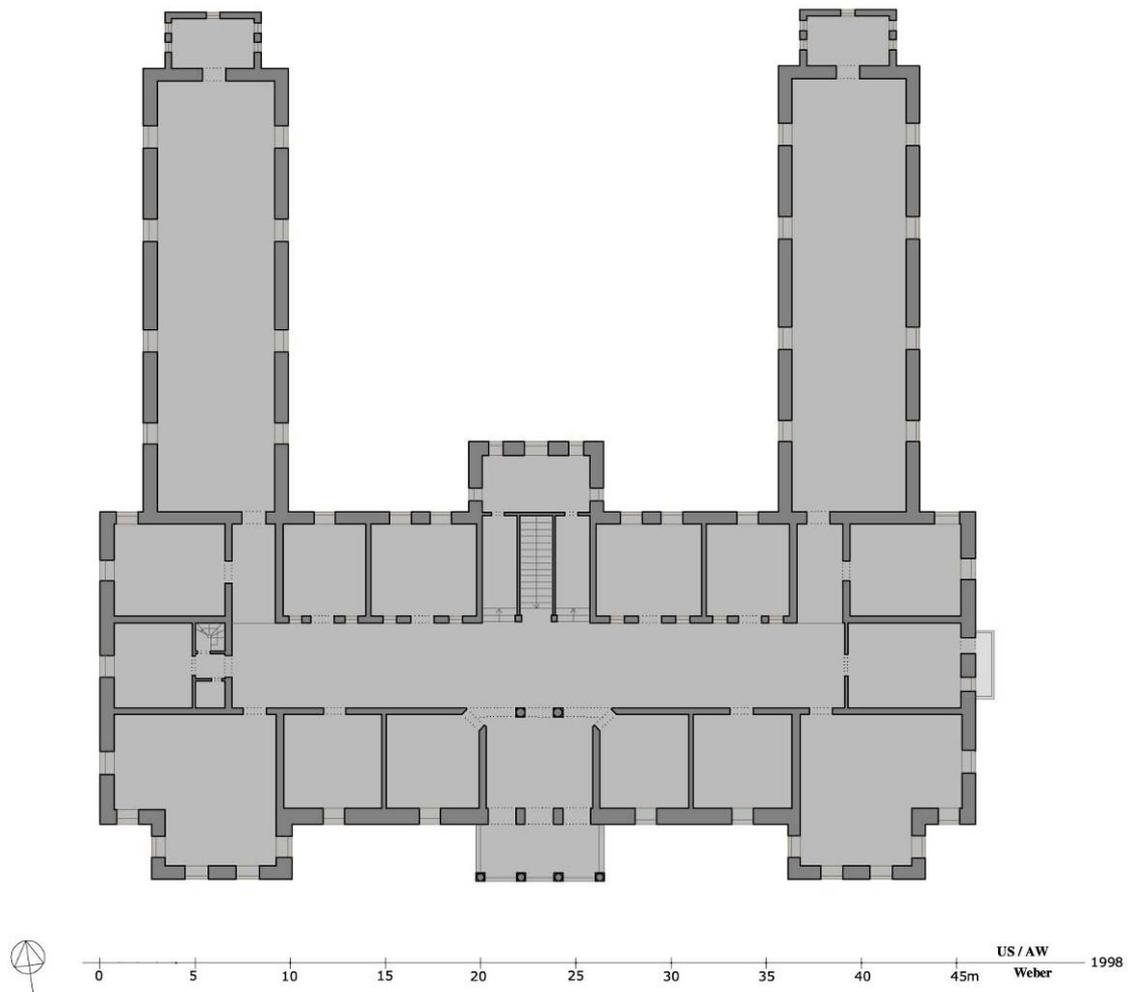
Krankenhaus al-Ġurabā, Grundriss OG
